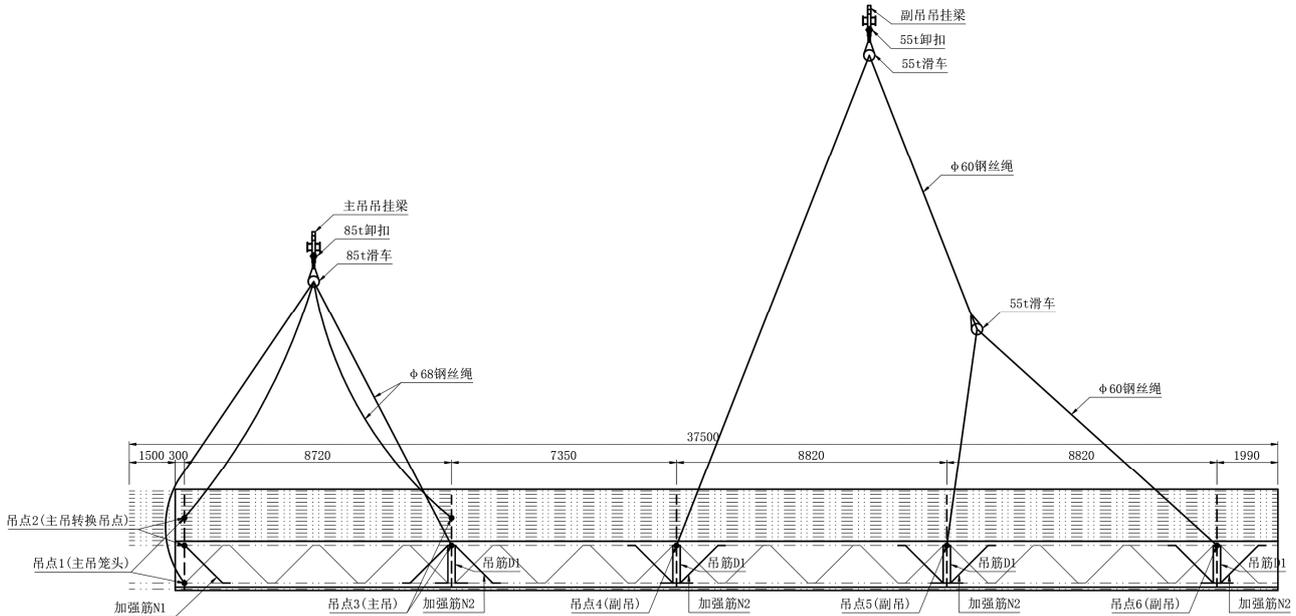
长度方向钢筋笼吊点布置图 (单位: mm)
